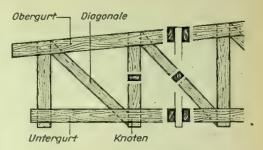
Genagelter Fachwerkträger (trapezförmig)
